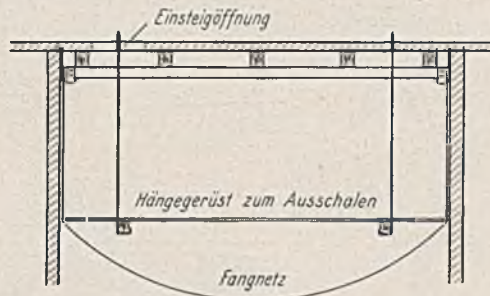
Schalung der Silodecken mit Z-förmigen Hängeeisen.
